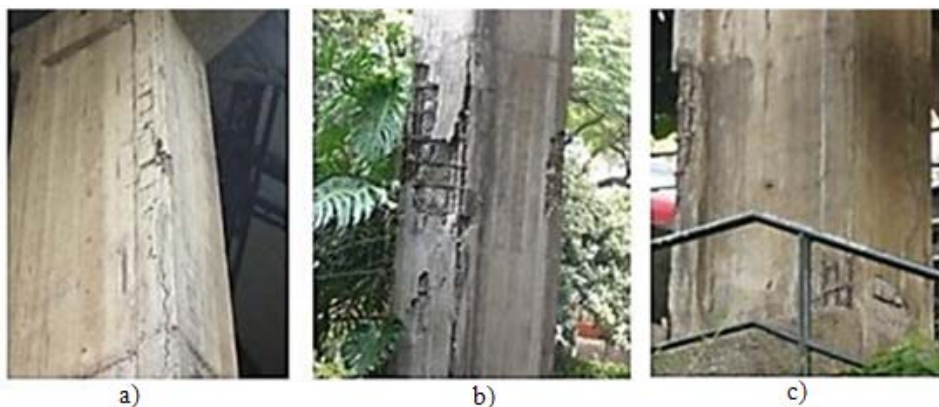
Pilares com degradação: a) Pilar P1; b) Pilar P2; c) Pilar P3 (Novembro de 2013)
